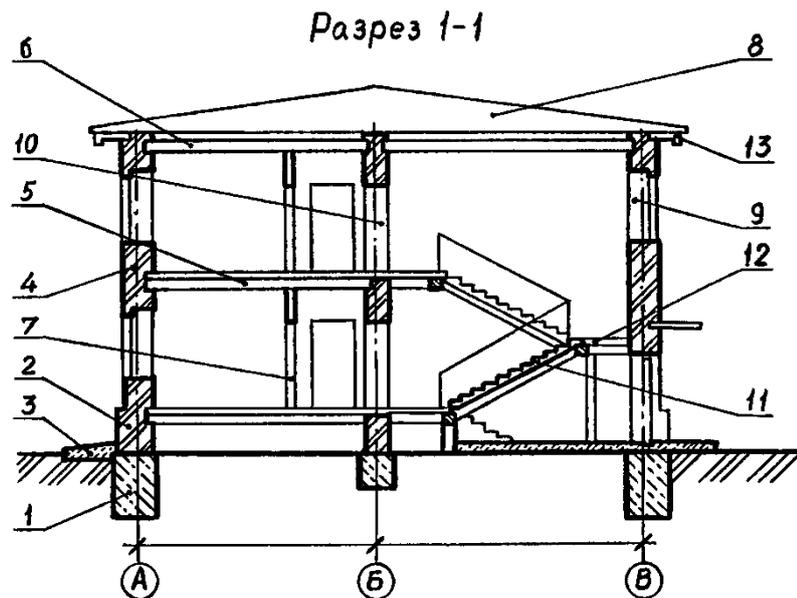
Основные конструктивные элементы зданий: 1 – фундамент; 2 – цоколь (нижняя часть наружной стены); 3 – отсстка (служит для отвода атмосферных вод от стен здания); 4 – стены; 5 – перекрытие междуэтажное; 6 – перекрытие кровельное; 7 – перегородки (разделяют смежные помещения); 8 – кровля; 9 – оконный проем; 10 – дверной проем; 11 – лестничный марш; 12 – лестничная площадка; 13 – карниз (верхняя часть стены, которая служит для отвода атмосферных осадков от стены)
